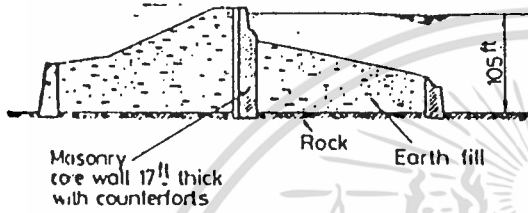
โครงสร้างประเภท Retaining Wall ในยุคโบราณ
